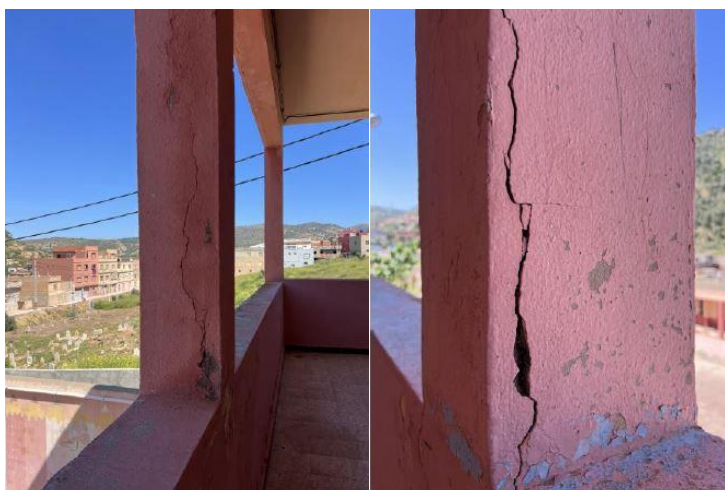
11: fissurations avancées des poteaux de 1er étage Bloc C [43]
